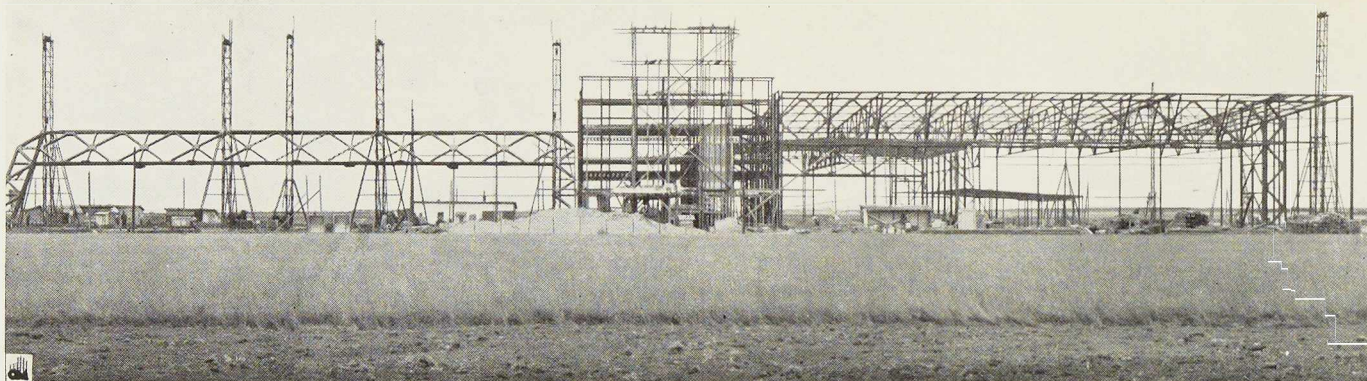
Vue d'ensemble des trois hangars soudés exécutés à Prague.
